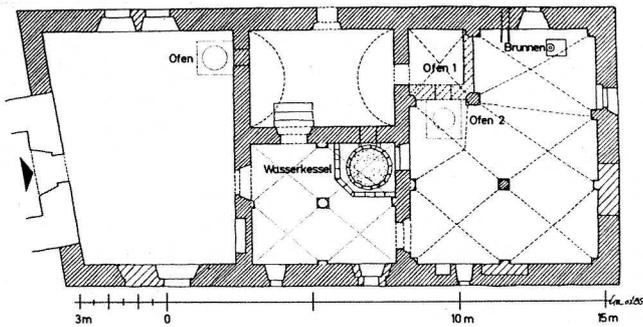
Blaubeuren, Klosterhof (Badstube) Grundrissplan Erdgeschoss 1977 (nach Cramer 1985).
